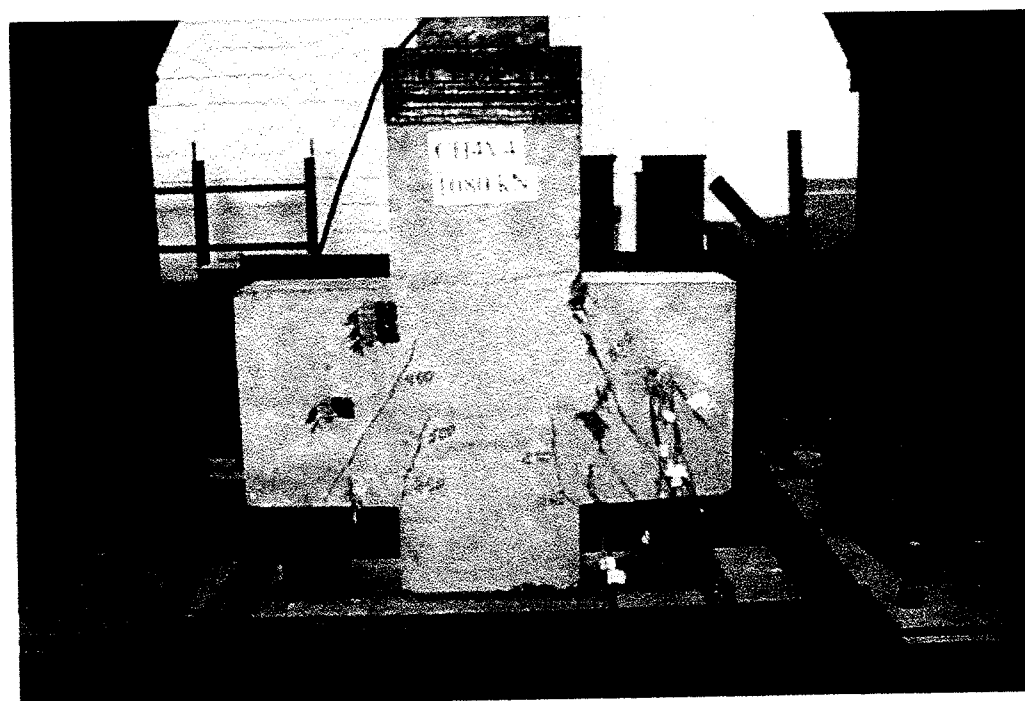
Exemplo de fissuração e ruína dos consolos
